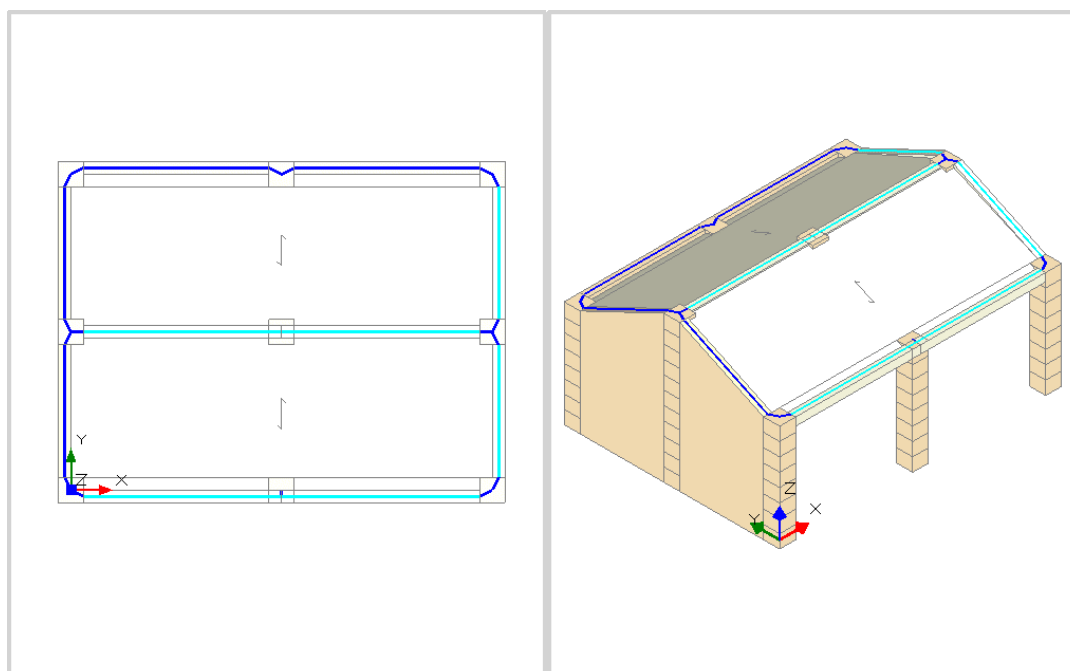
Costruzione Rurale in Muratura: Vista in Pianta e in Assonometria
